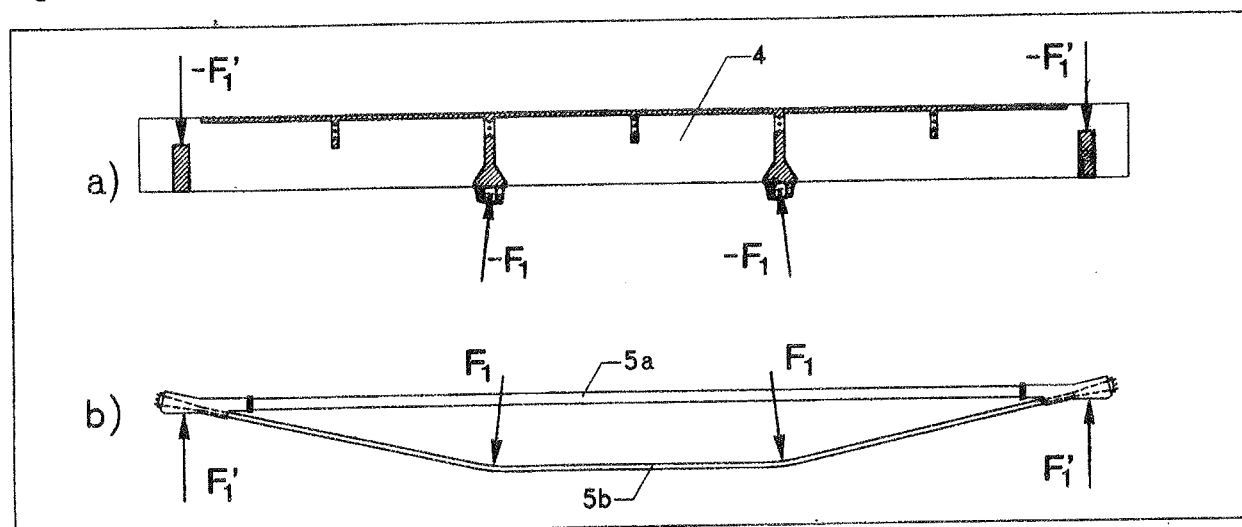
forze nella SCSSP (1) dovute alla tesatura del tirante (5b) – a) forze applicate alla struttura primaria
